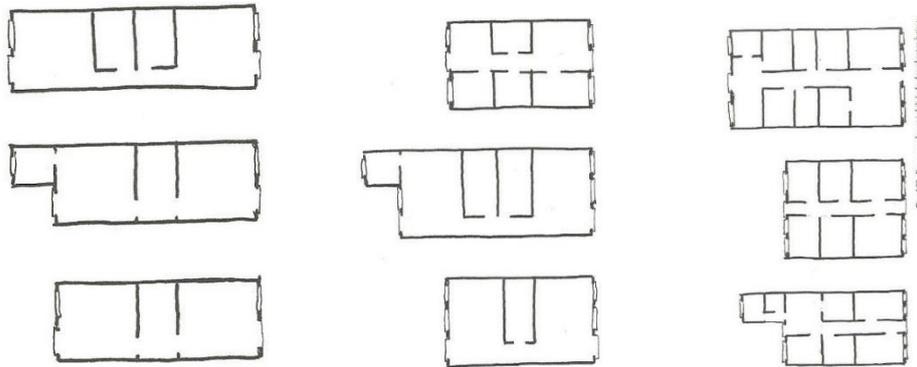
Planta baixa da casa porta e janela e seu desenvolvimento.
